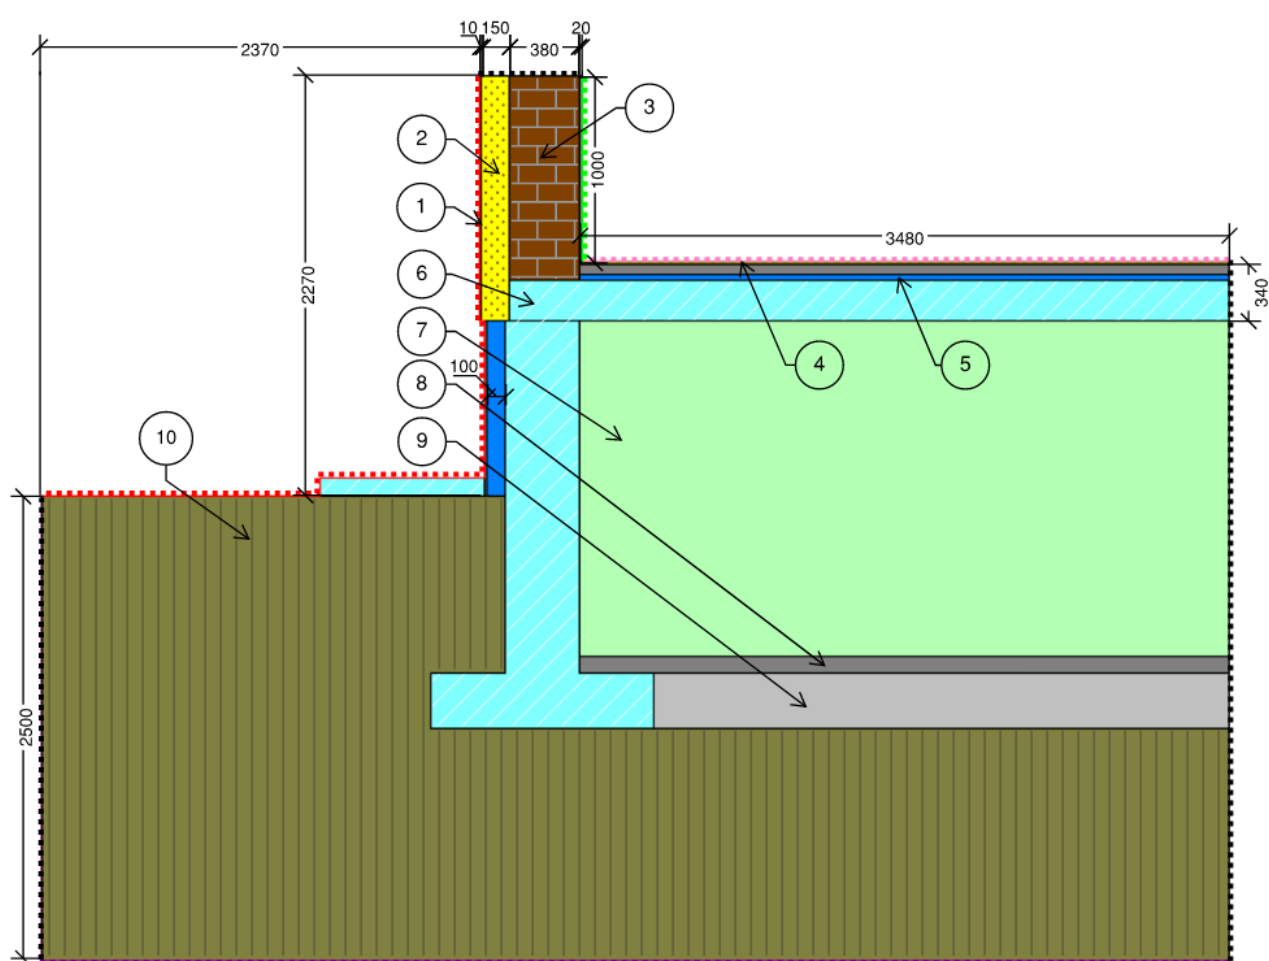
Схема вузла примикання плити перекриття підлоги над неопалюваним підвалом до стіни цоколя
